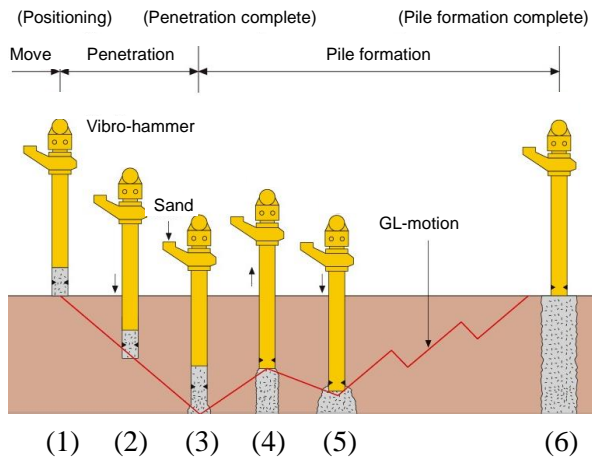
SCP工法の施工規模³⁾に加筆・修正
